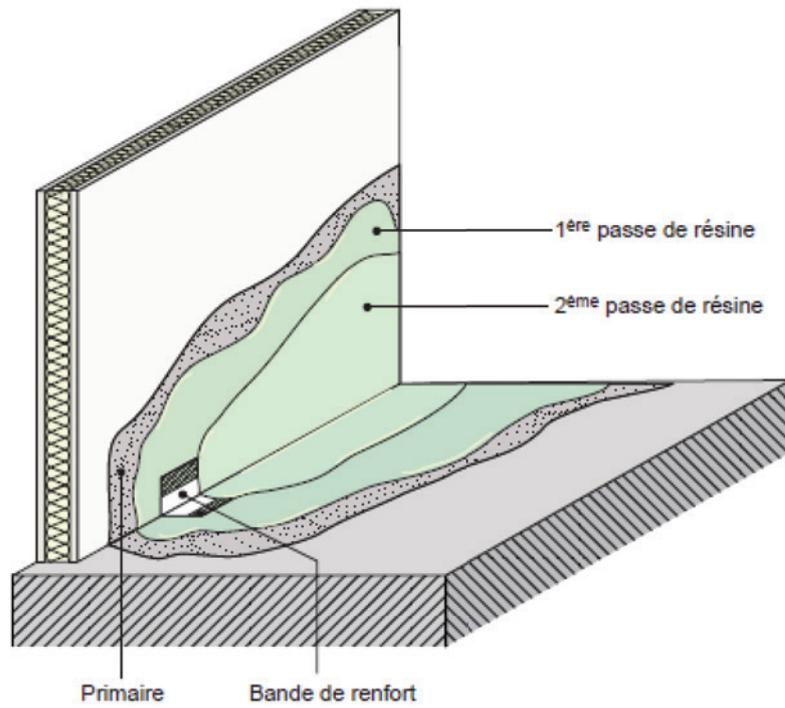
Raccordement sol-paroi verticale : cas d'un carrelage au sol et sur la paroi
